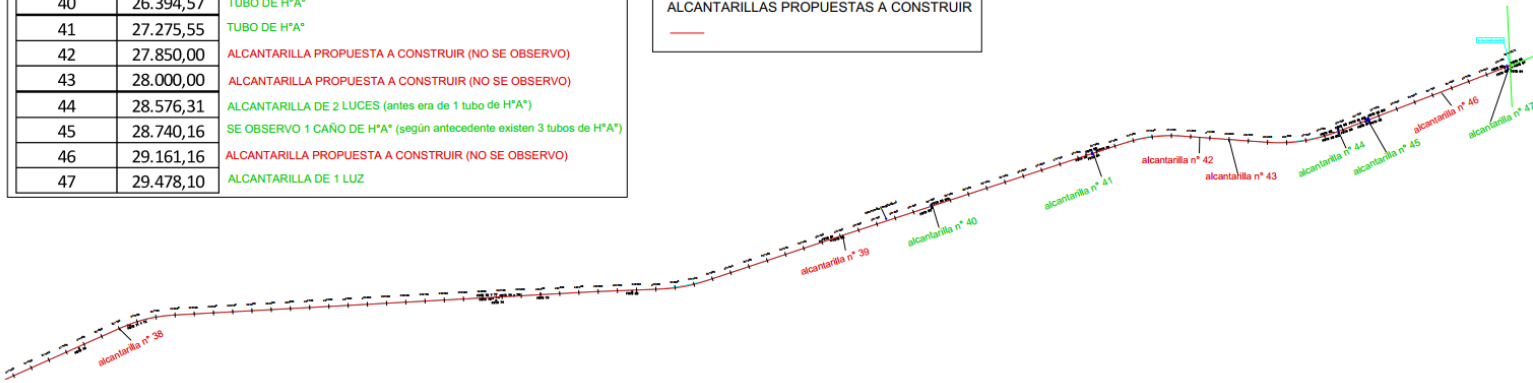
Plani-altimetria con ubicación de alcantarillas existe – Fuente: Elaboración propia.
